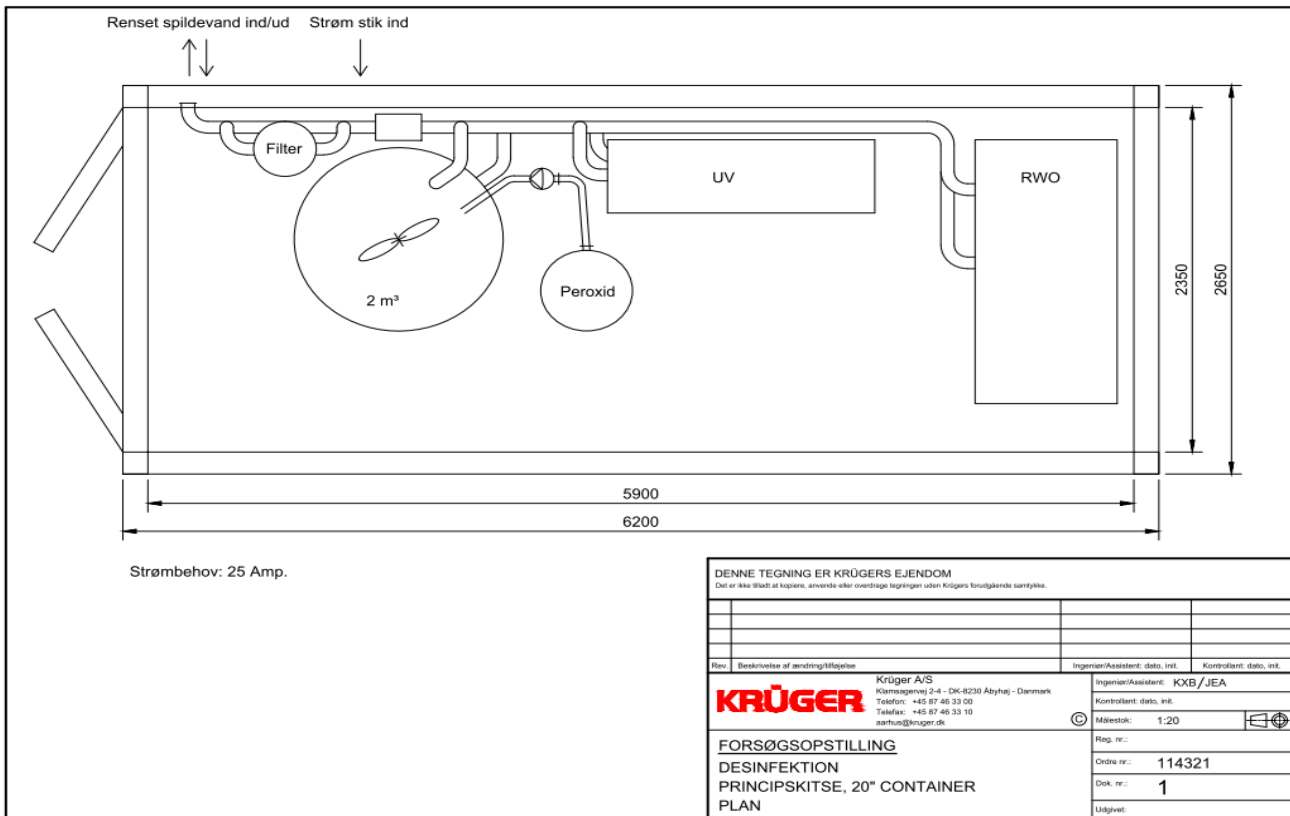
Test-container samt 10 m^3 tank for håndtering af overløbsvand.
